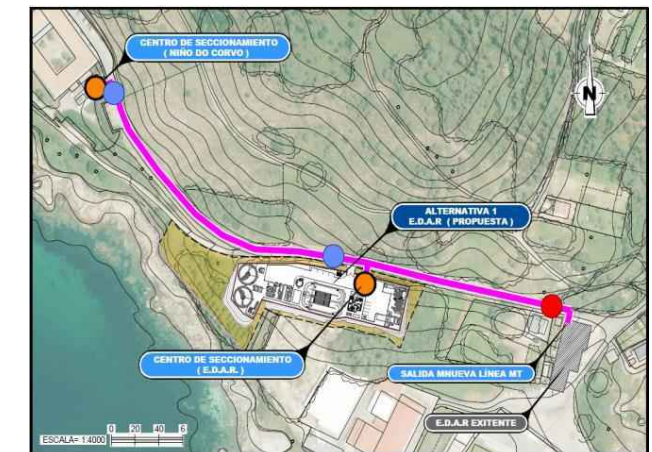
Presupuesto y equipamiento de "Compañía de Electrificación, S.L." y planta de Acometida MT. Alternativa 1
